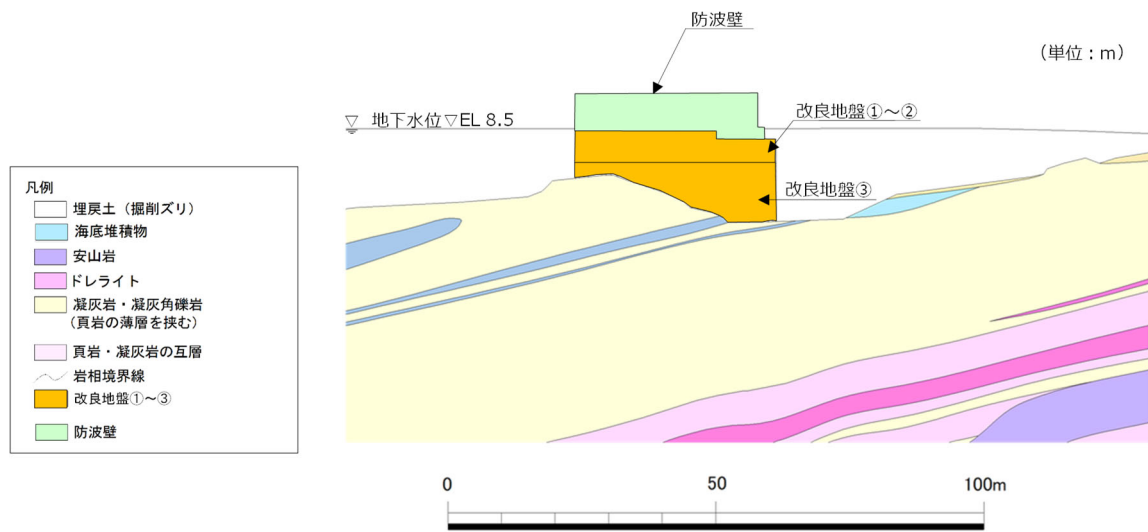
防波壁 (逆 T 擁壁) の横断面図 (⑦-⑦断面)
